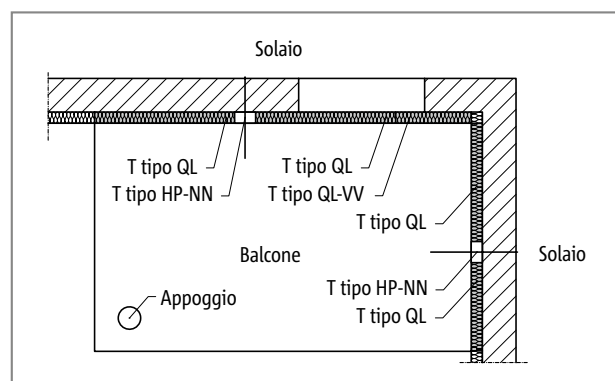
Schöck Isokorb® T tipo HP: balcone appoggiato su due lati con pilastro
